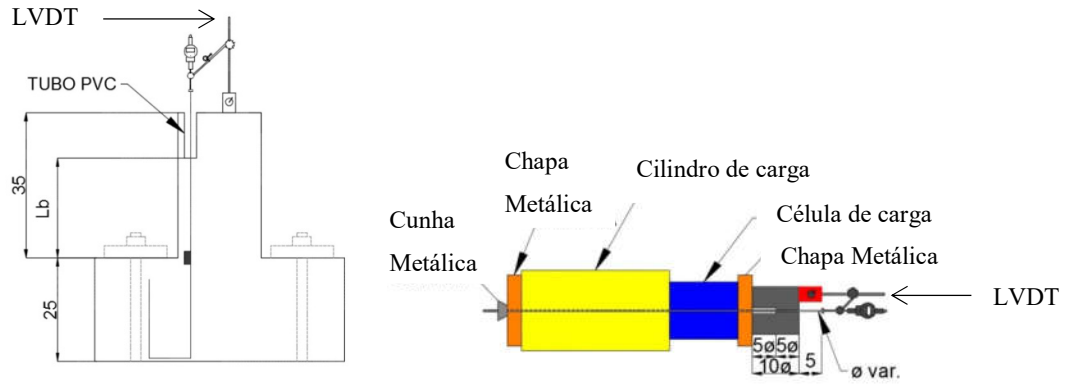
Localização do LVDT para medição do deslizamento da barra ancorada nas vigas (dimensões em cm).
